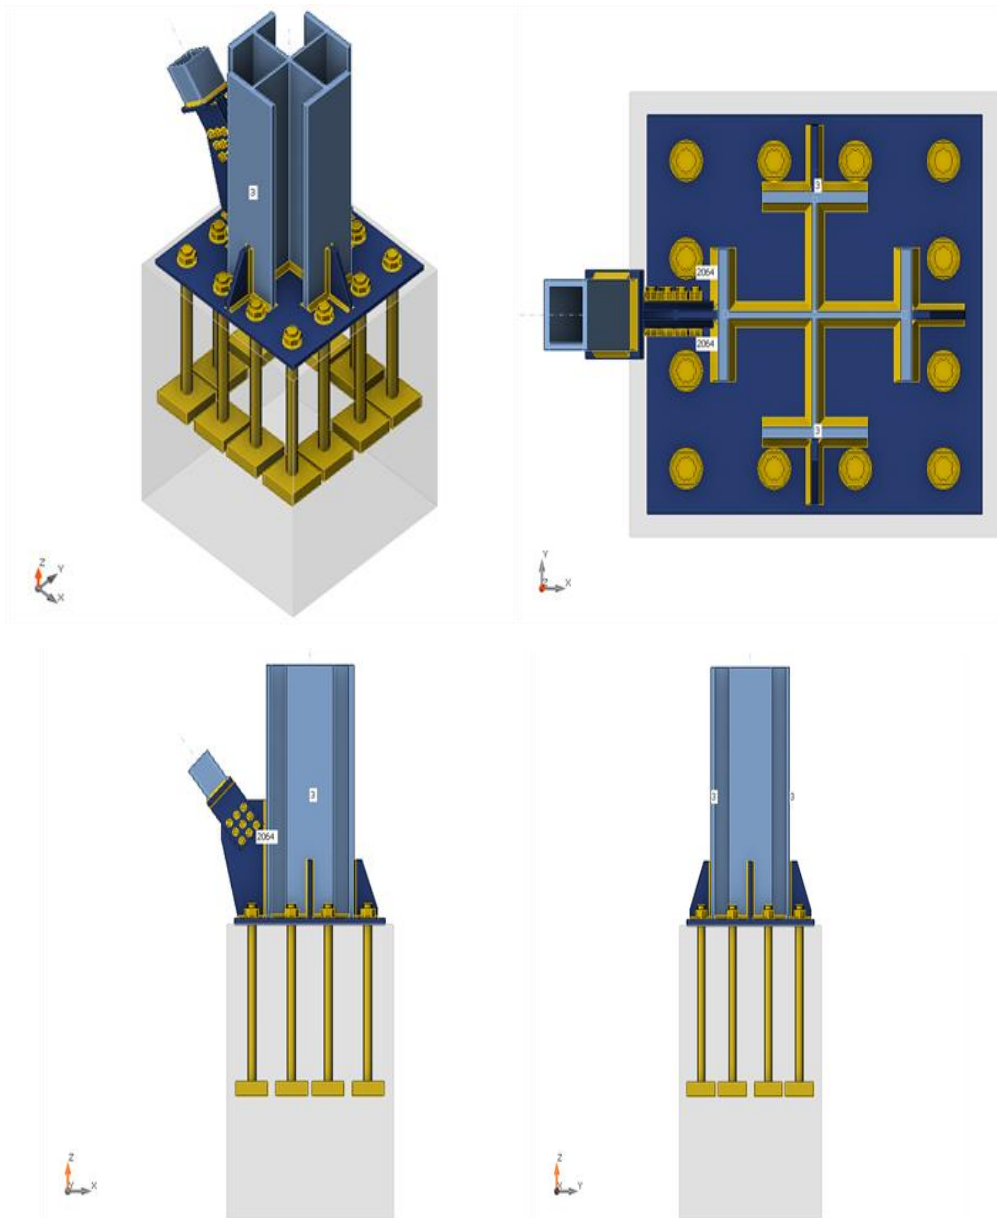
Vue d'assemblage pied de poteau-contreventement.
